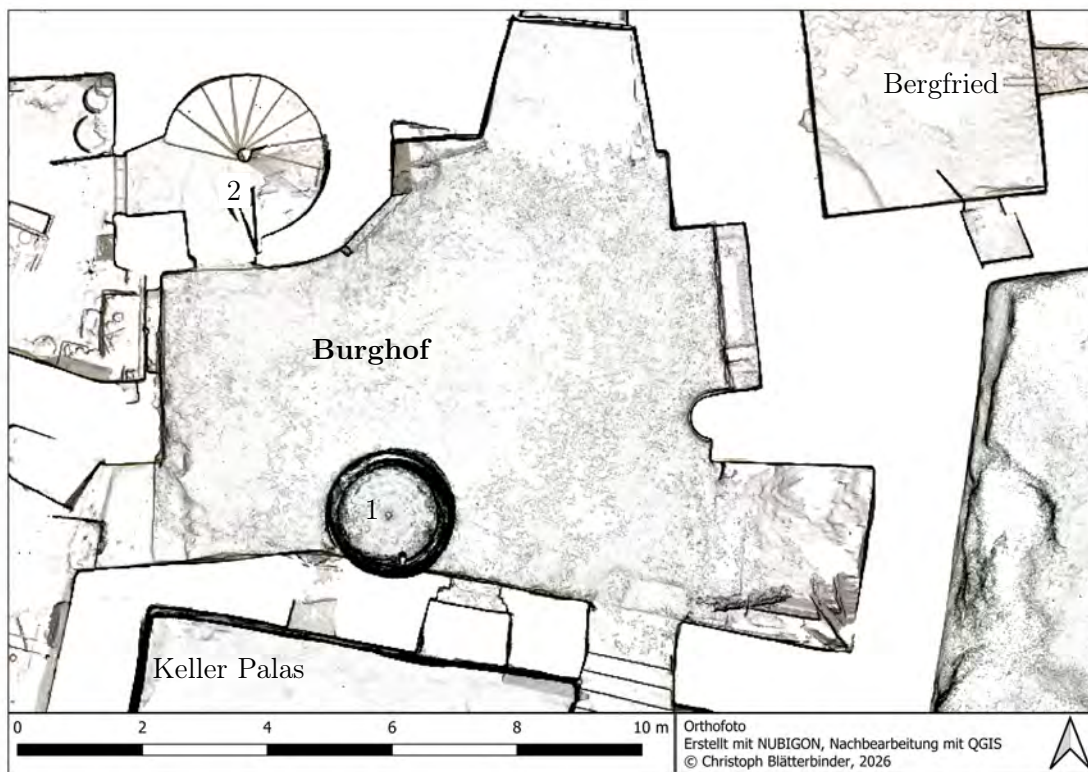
Plan des Burghofs (Erdgeschoss): Brunnen (1); Wendeltreppe (2).
